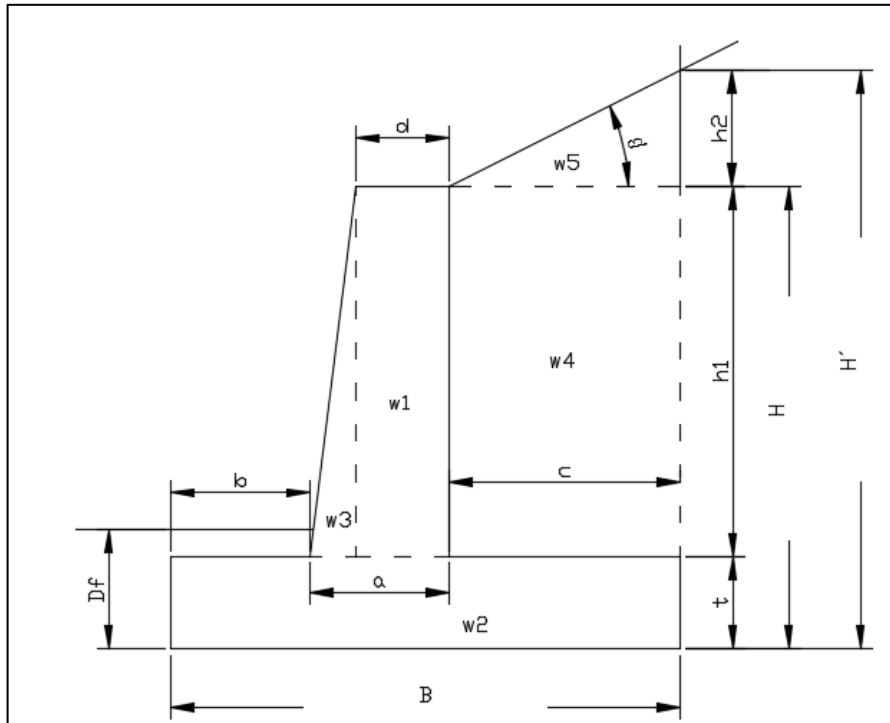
3. Predimensionamiento Muro en Voladizo.
